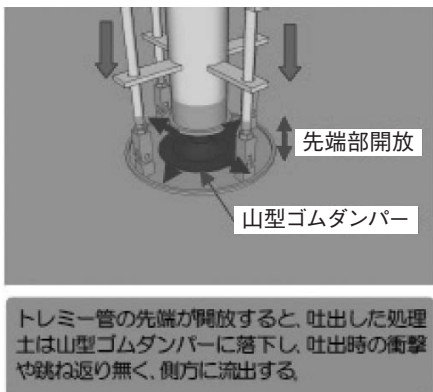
計量混合処理土(-13m岸壁)の施工ステップ
